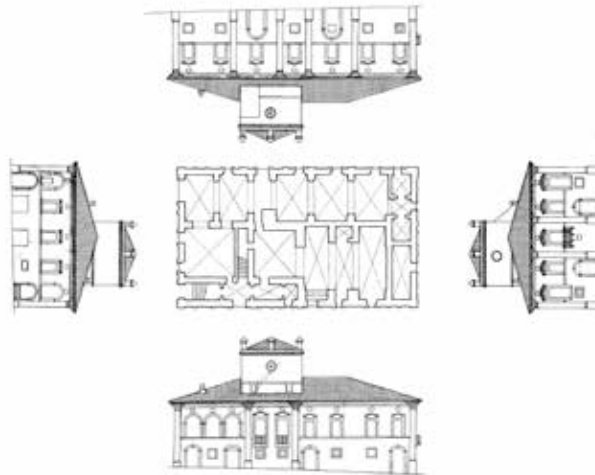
Casino Sorricchio, pianta ed elevati. Elaborazione degli autori, Laboratorio di Storia, DdA, Unich
